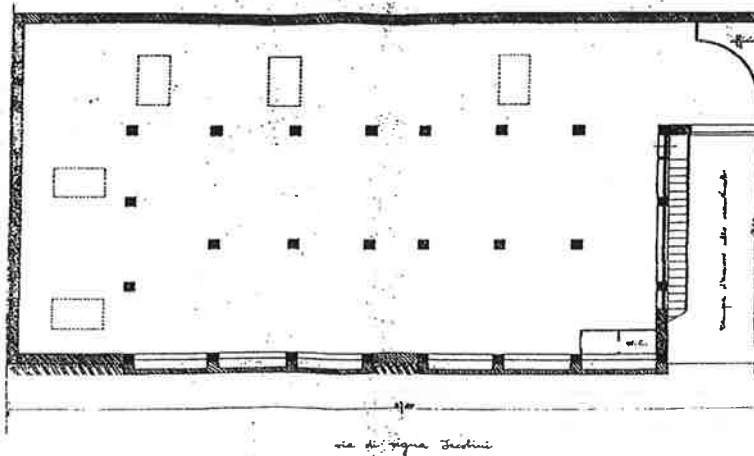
Edificio in Via Vigna Jacobini : pianta piano interrato
